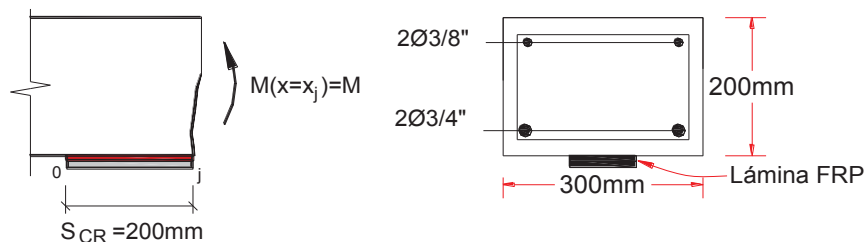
elemento de viga entre dos grietas sujeto a flexión pura
